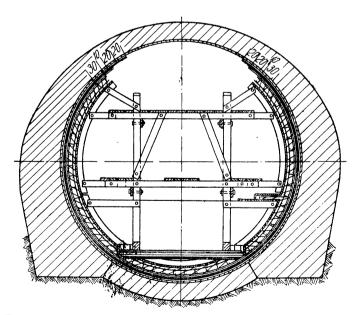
Схема устройства оклеечной гидроизоляции в стенках тоннеля
